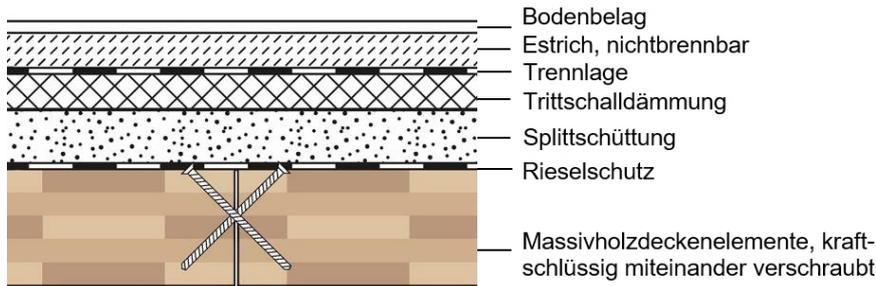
unbelagte Massivholzdecke mit verschraubter Elementfuge und mehrschichtigem Fußbodenaufbau (Vertikalschnitt) [Muster-Richtlinie 23.05.19]
